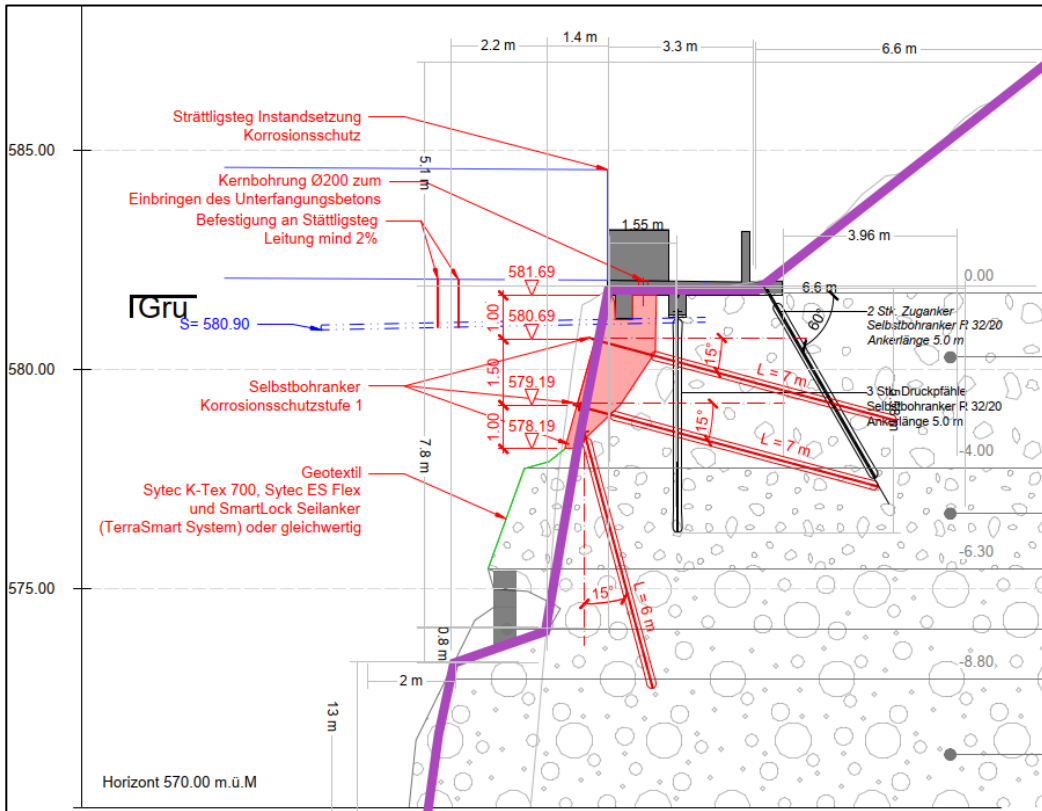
Berücksichtigte Terrainlinie (violett) auf Grund des Ausbruchs bei der bestehenden Betonunterfangung
